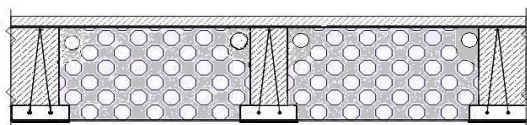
Схематичне зображення збірно-монолітного перекриття із застосуванням блоків з ніздрюватого бетону
